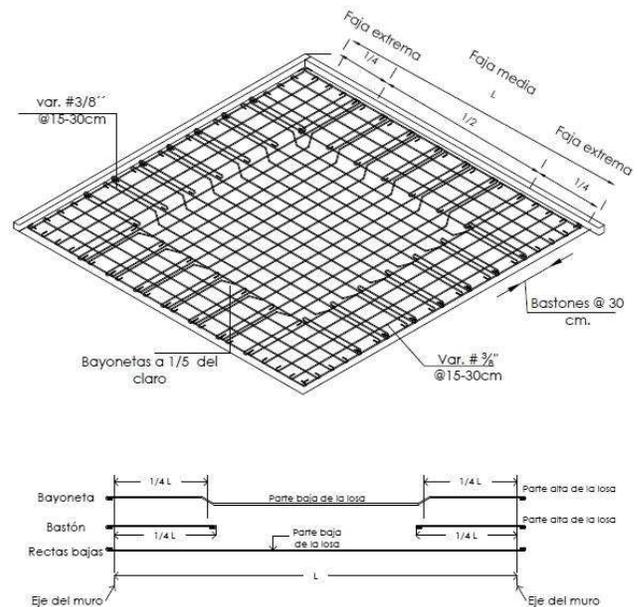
Detalle de colocación de acero de refuerzo en una losa
